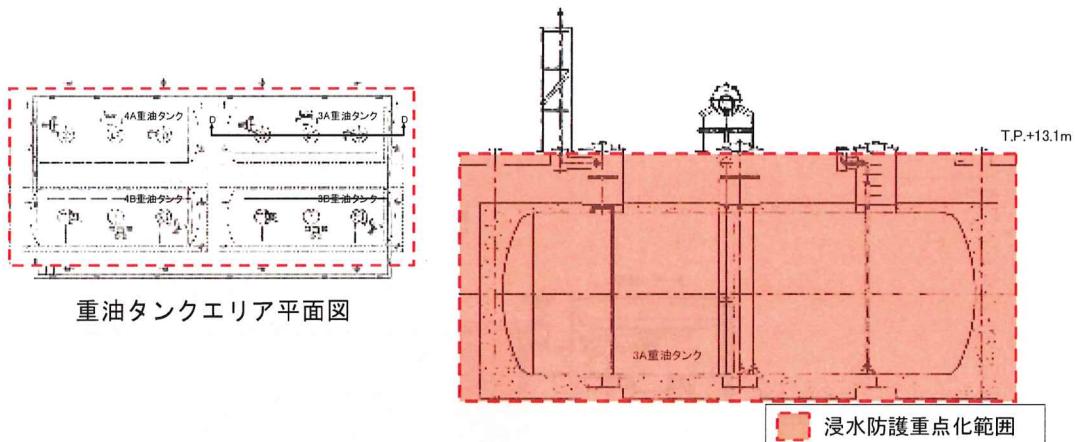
大飯 3, 4 号炉 重油タンク断面図 (D-D 断面)
